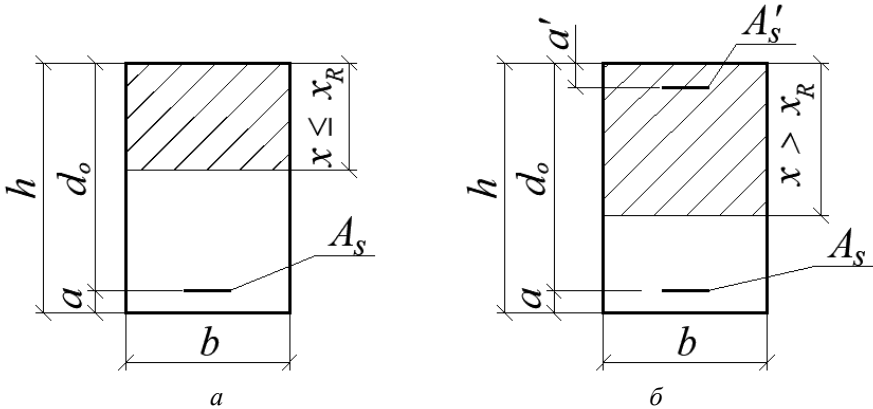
Випадки армування нормальних перерізів згинальних елементів:
